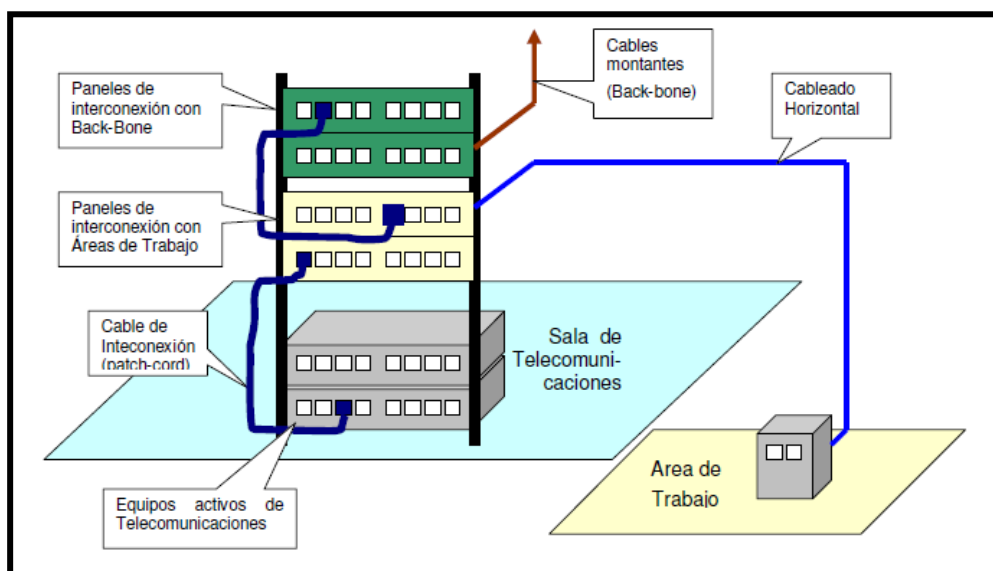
Distribución cableado horizontal en un edificio.
